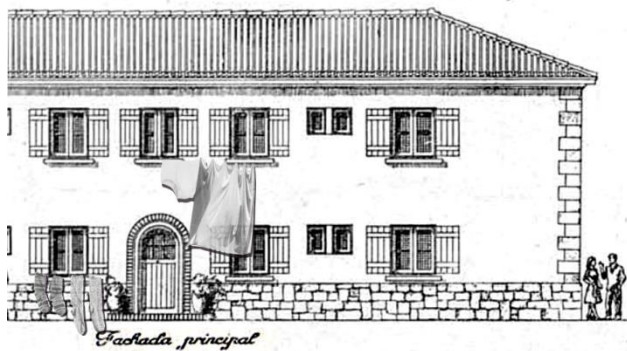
Giralt Casadesús, Ricardo y Margarit Serradell, Juan. *Alzados de las viviendas tipo D*, 1947. Fuente: modificado de Giralt Casadesús, Ricardo y Margarit Serradell, Juan. "Proyecto de poblado de pescadores en Rosas". *Cuadernos de arquitectura*, nº8 (1947): 42.
